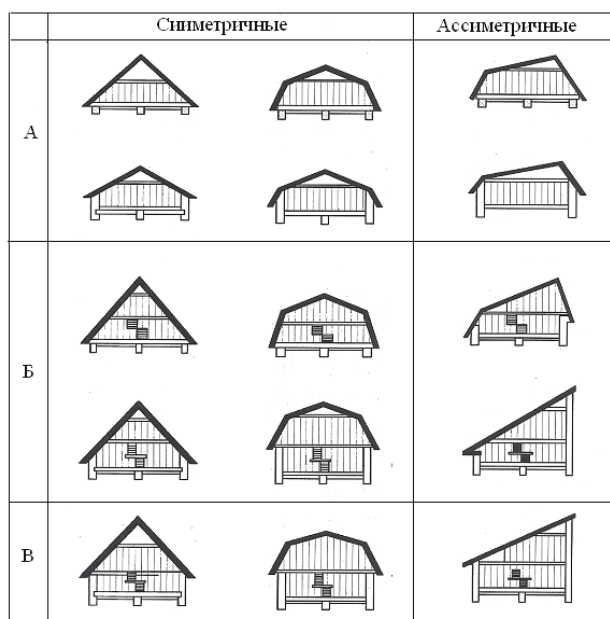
Типы мансардных этажей по видам кровли и уровням
